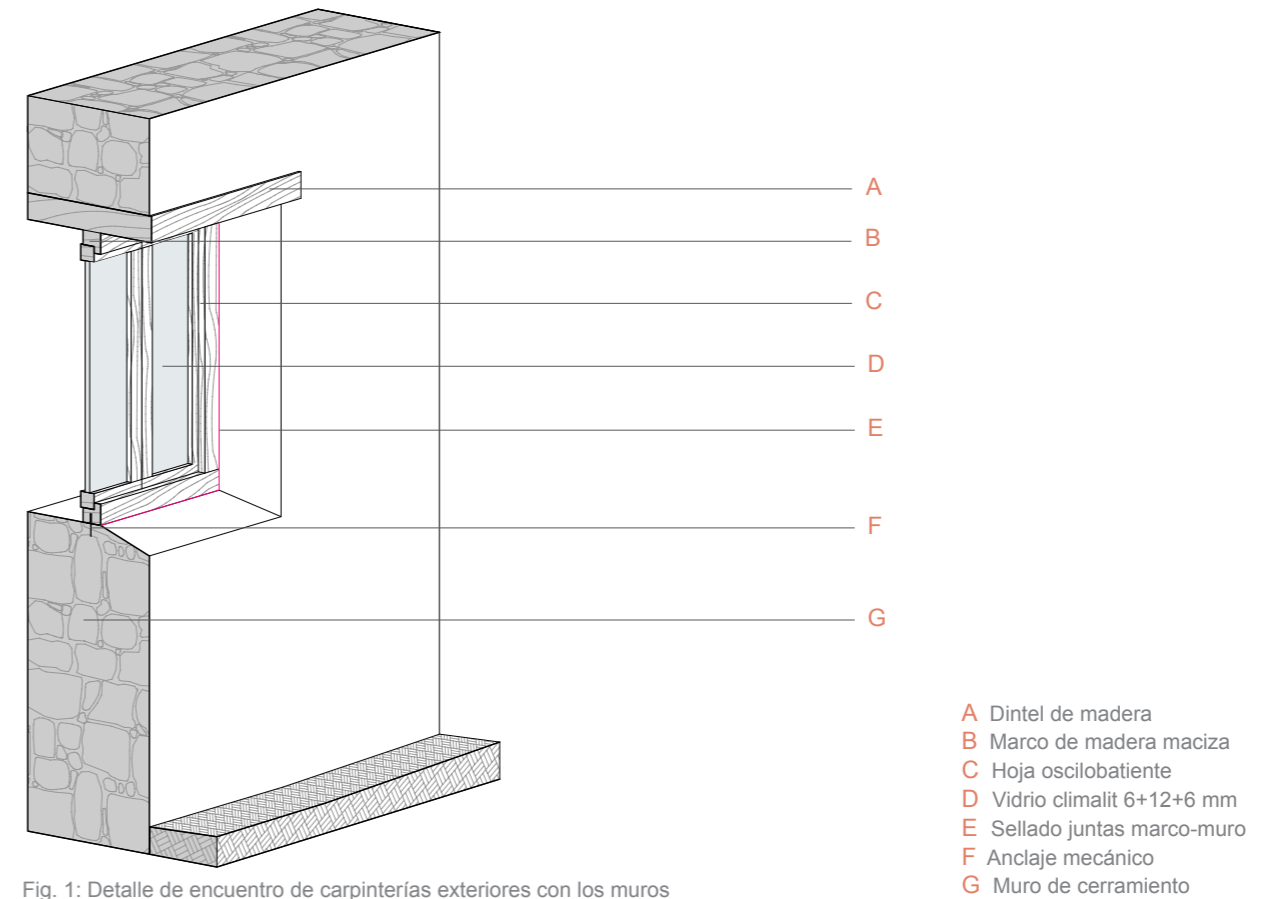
Detalle de encuentro de carpinterías exteriores con los muros
